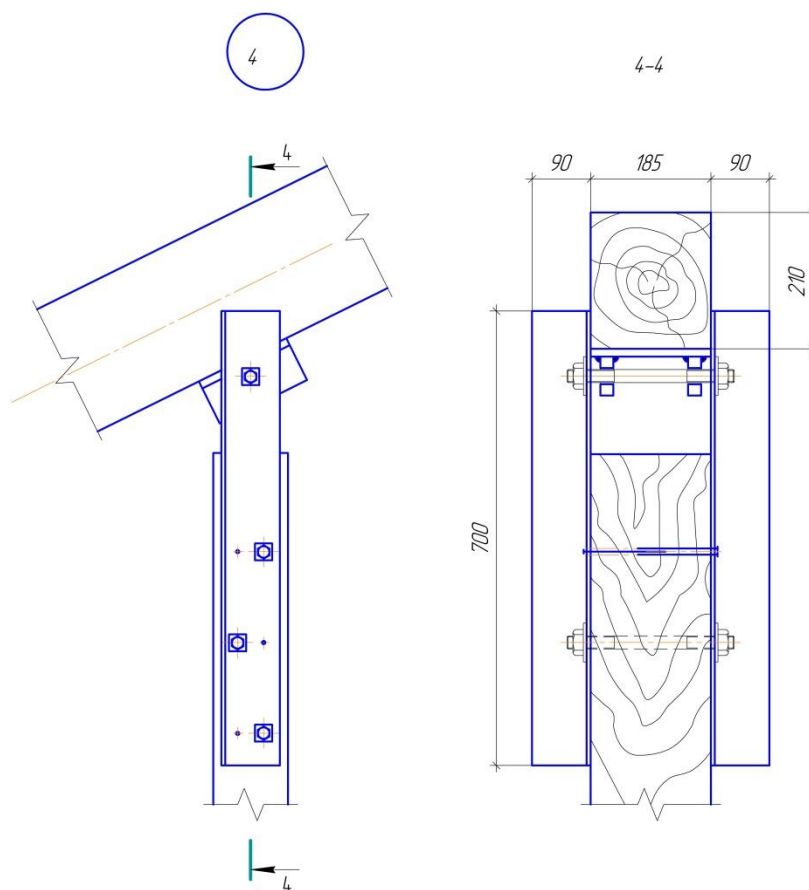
Конструкция узла верхнего пояса в месте примыкания стойки.
